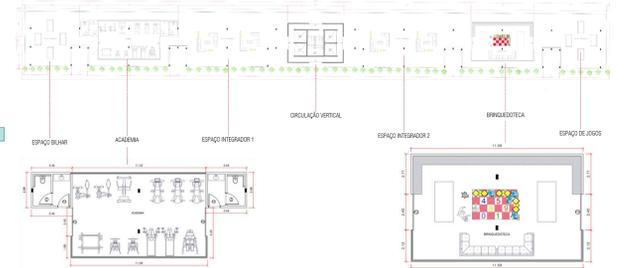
Planta do Pavimento Livre (8º Andar) do Complexo Habitacional. Criada e Editada pelo autor.
